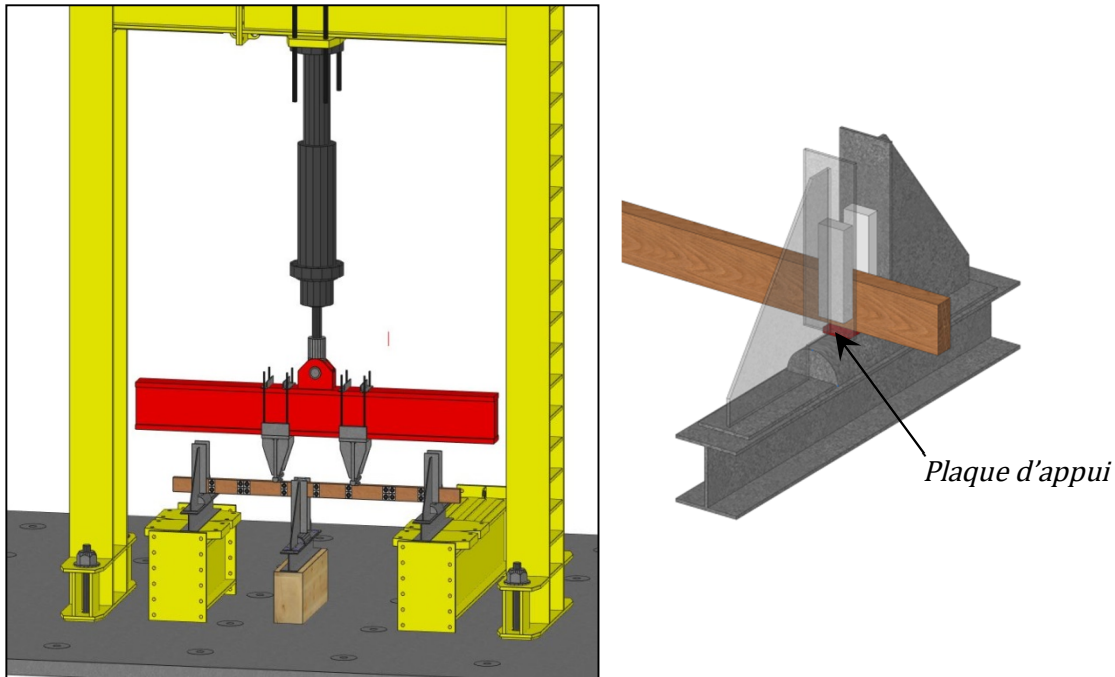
Montage de flexion sur la dalle d'essais.
